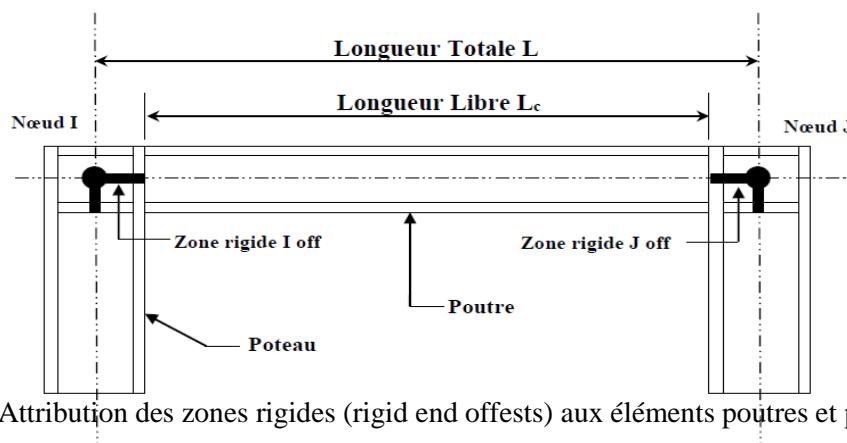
Attribution des zones rigides (rigid end offsets) aux éléments poutres et poteaux[24]
